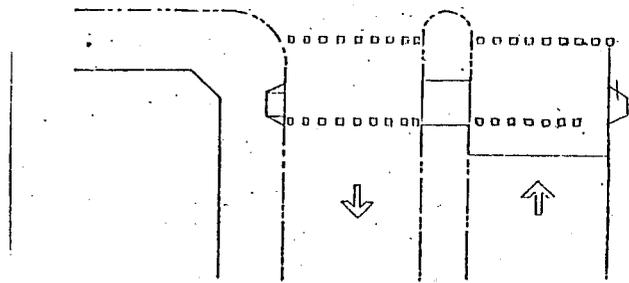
ESQUEMA DE REBAIXAMENTO DE GUIA EM CANTEIRO CENTRAL SUPERIOR A 3,00m.
